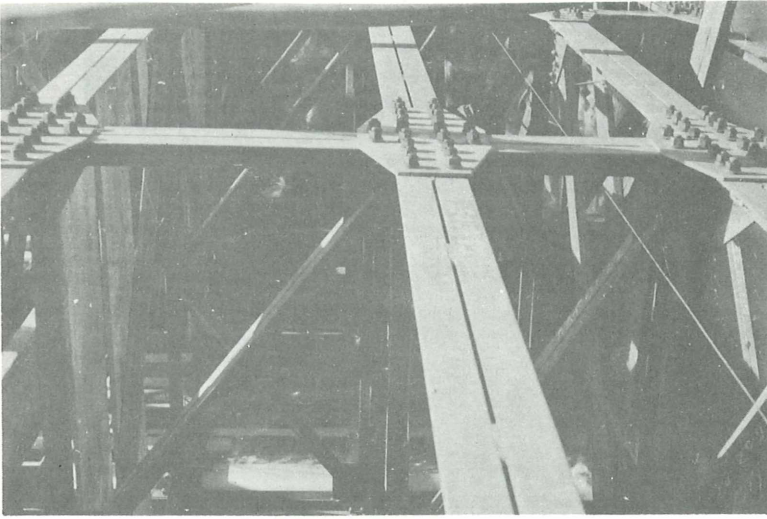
Detail der Sperre. Im unteren Bildteil ist ein Meßdraht, knapp vor dem senkrechten Balken das Lotseil erkennbar
